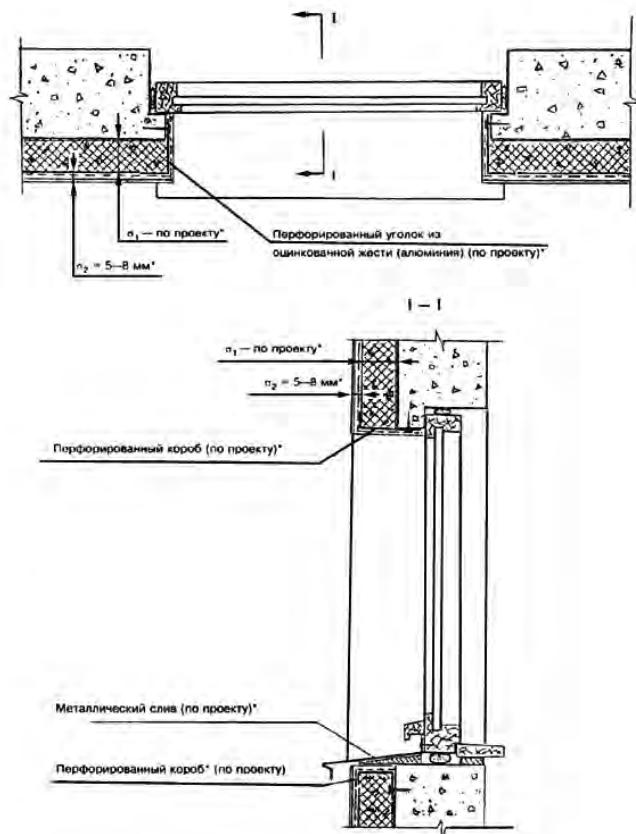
Фрагмент примыкания теплоизоляционного слоя к оконному проему (вариант "с четвертью")
